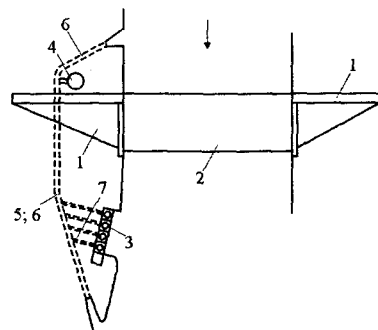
Схема компоновки гидроузла с водосливной плотиной из укатанного бетона и совмещенным со строительным тоннелем энергетическим водоводом:
